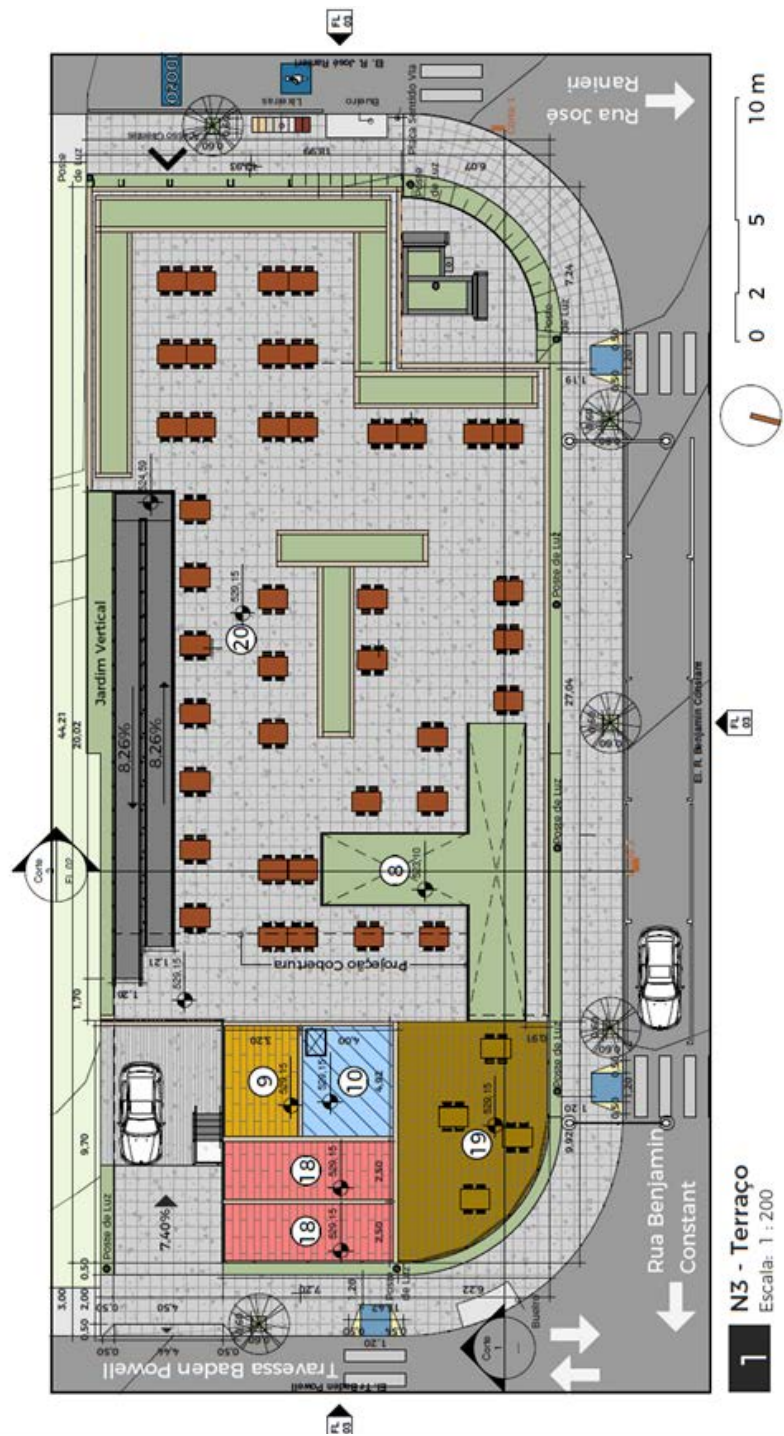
Planta Terraço. Fonte: Elaborado pelo autor (2023).
